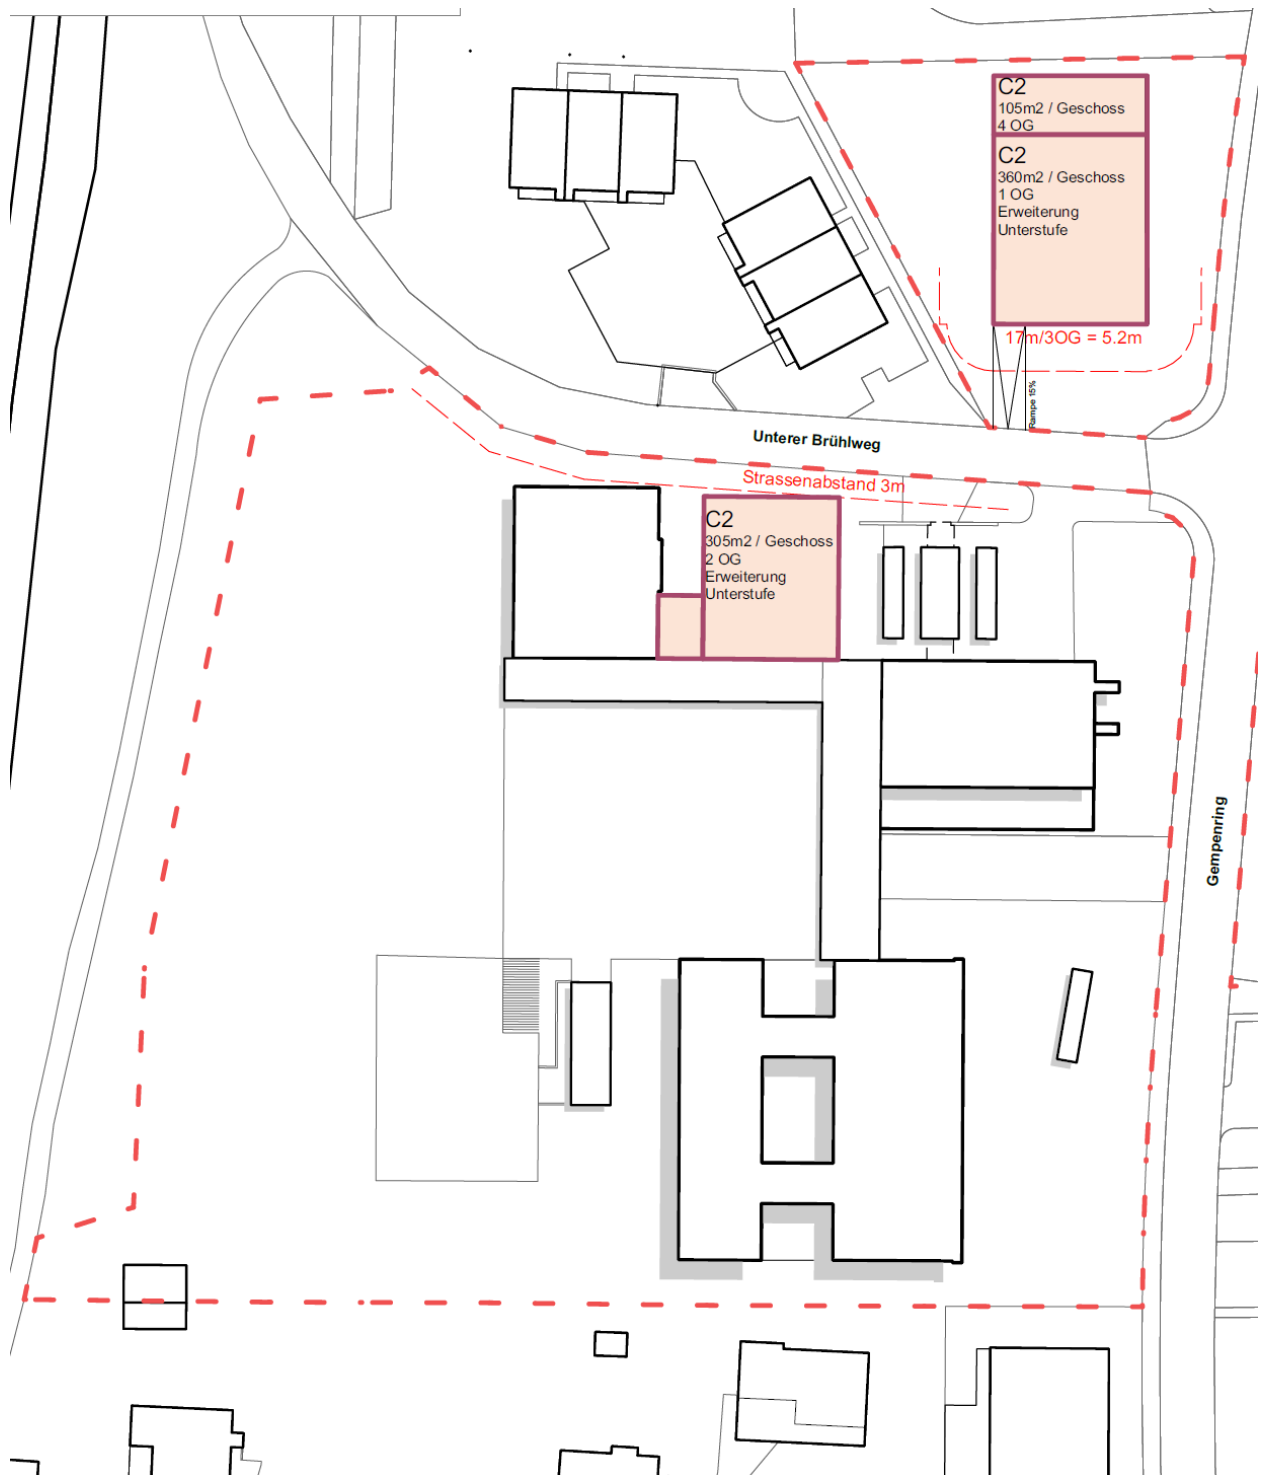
Etappe 2, Grundriss C.2
